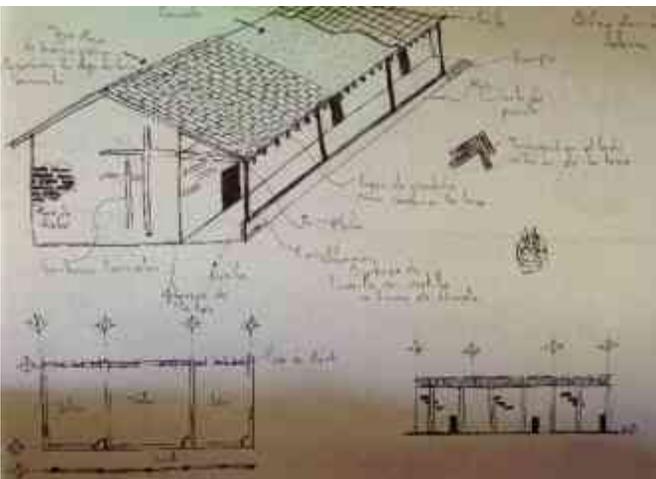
“Propuesta en planta y perspectiva de los dormitorios y talleres”
